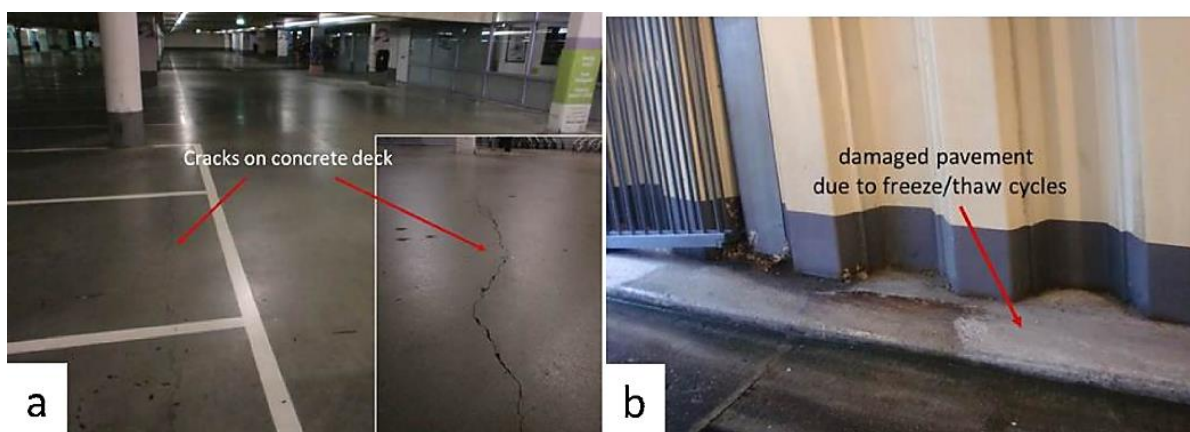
Localização de aplicação do sistema de reparação à base de bactérias: (a) fissuras observadas no pavimento; (b) danos no pavimento por exposição à ação gelo/degelo [53]
